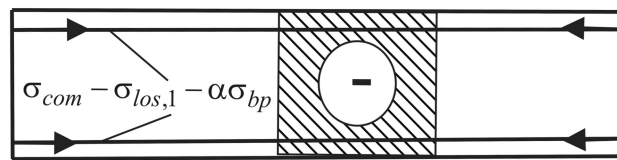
Схема напружень у попередньо напруженій залізобетонній балці після відпуску натягу арматури.
